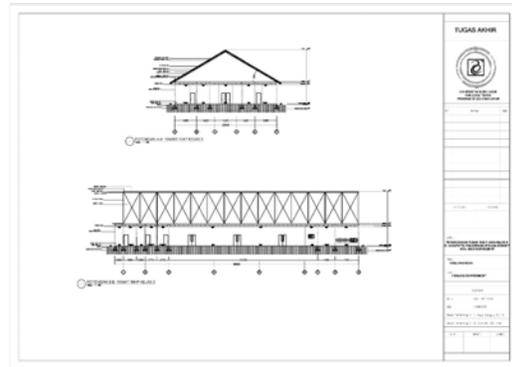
Tampak Samping Bangunan Rawat Jalan
